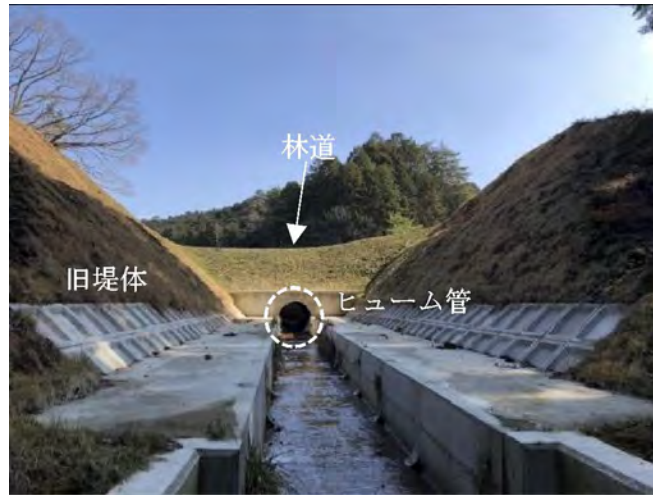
堤体開削工法と暗渠工法の複合工法の事例¹⁾
